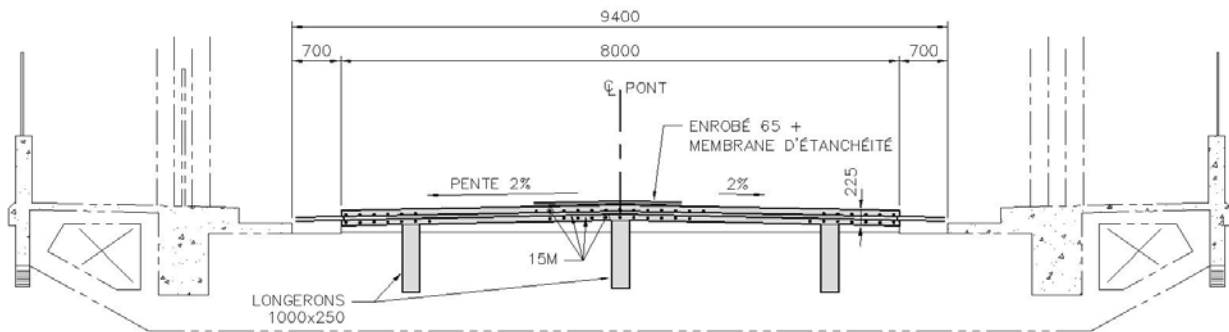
Coupe de la dalle de tablier au niveau des voies carrossables
